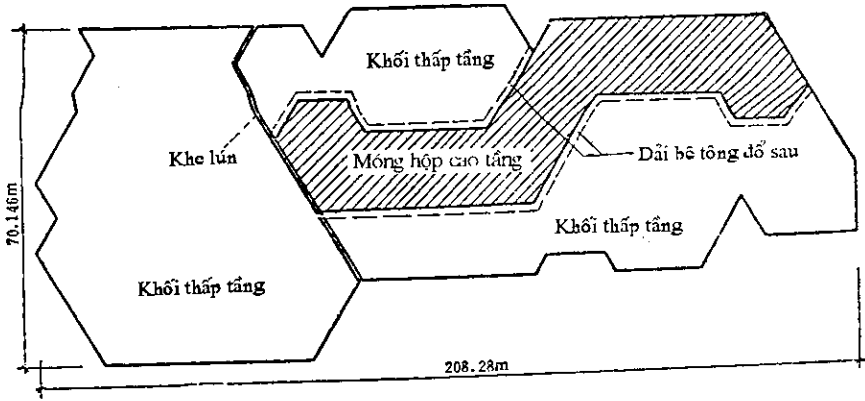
Mặt bằng móng khách sạn Tây Uyển
